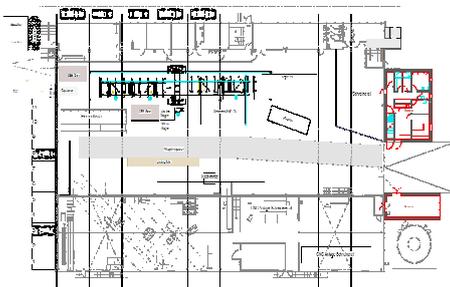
Bestehender Grundriss Produktionshalle
